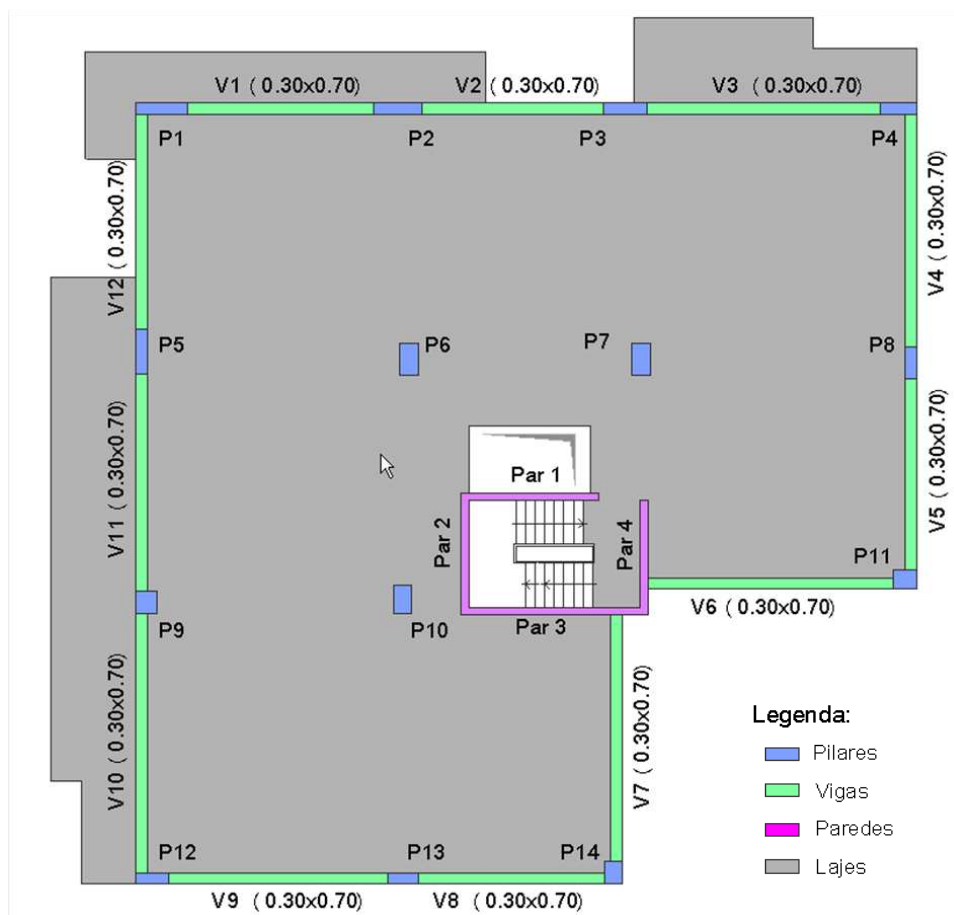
Planta estrutural adoptada para o piso tipo.
